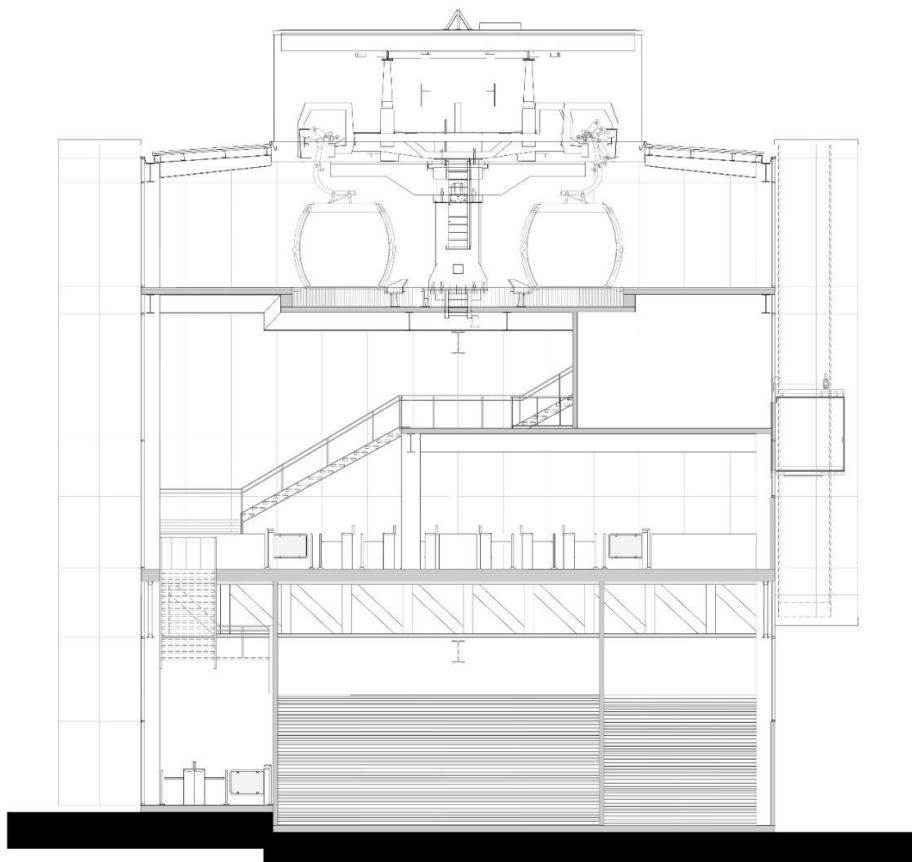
Corte Transversal de estación 6 Metro Constituyentes – Los Pinos
